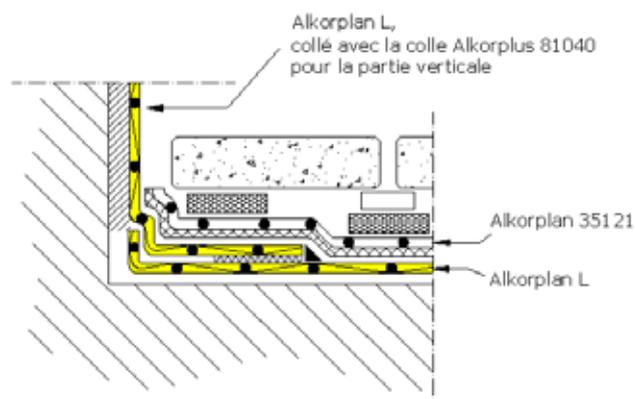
Solution alternative pour la fixation en rive de l'Alkorplan® L de 1,2 mm d'épaisseur : lestage avec des dalles en béton dans le cas où la fixation mécanique en rive n'est pas possible
